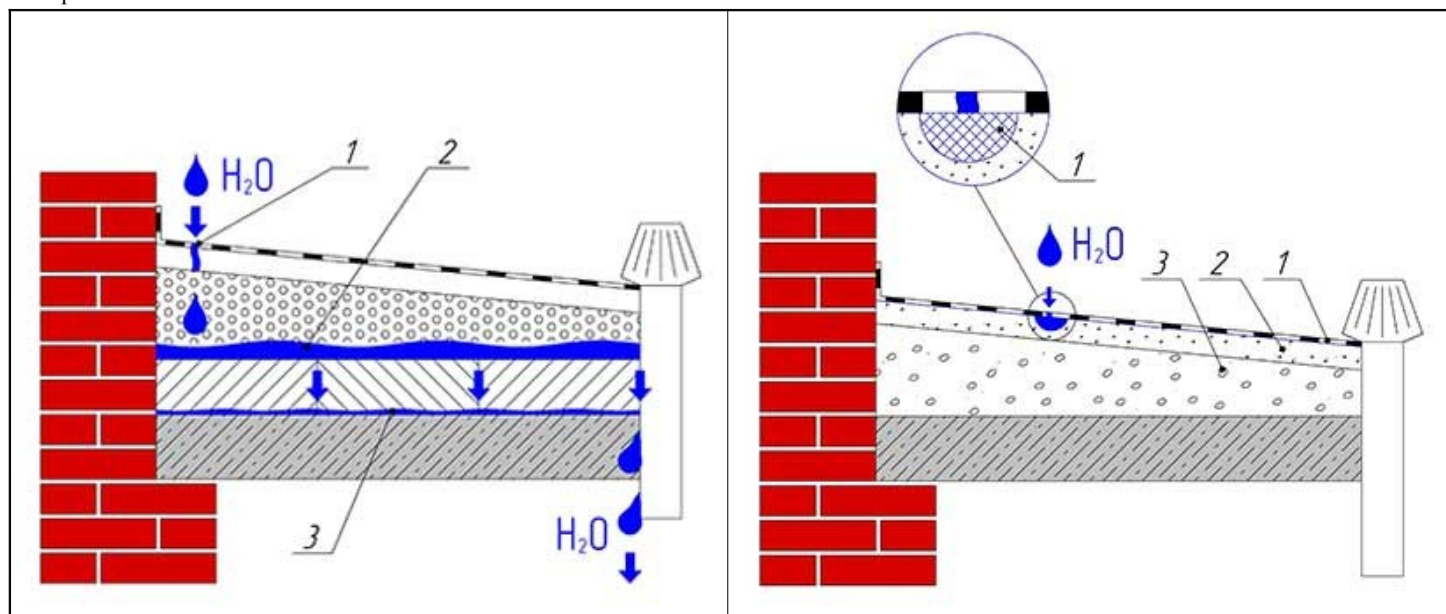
Протечка воды в традиционную кровлю. Через поврежденную гидроизоляцию вода заполняет собой слой керамзитового гравия и пустоты под слоем теплоизоляции. Затем через неплотности в основании кровли вода попадает внутрь помещения.
